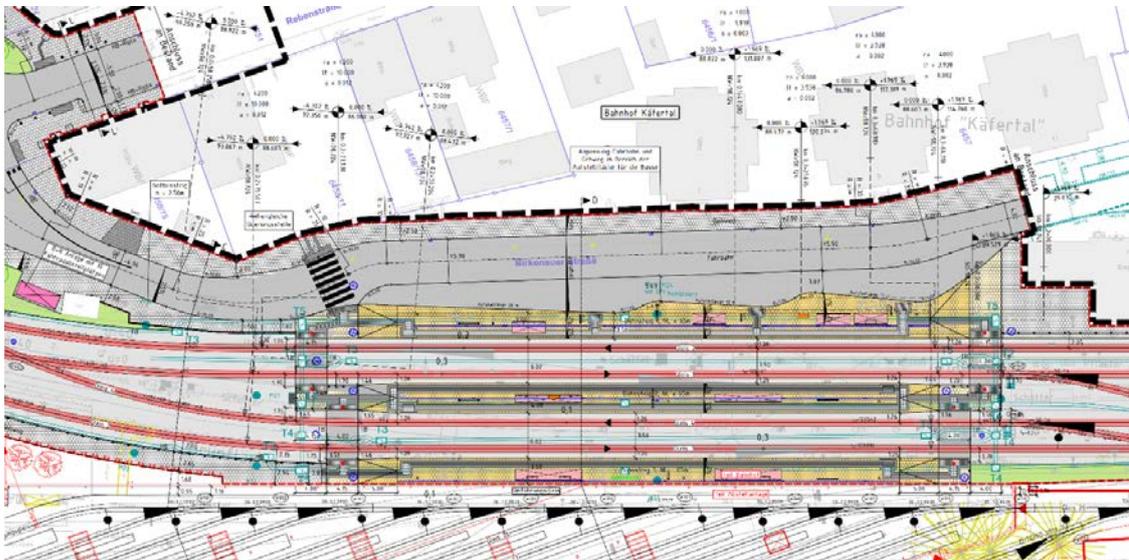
Lageplanausschnitt neue Planung Bahnhof Käfertal
